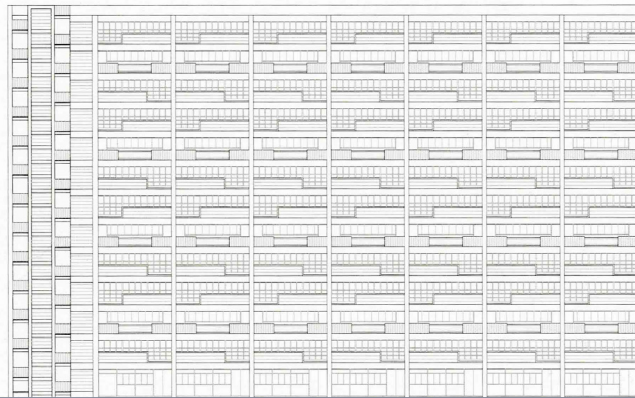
\_Alzado este, bloque de viviendas 13 niveles
